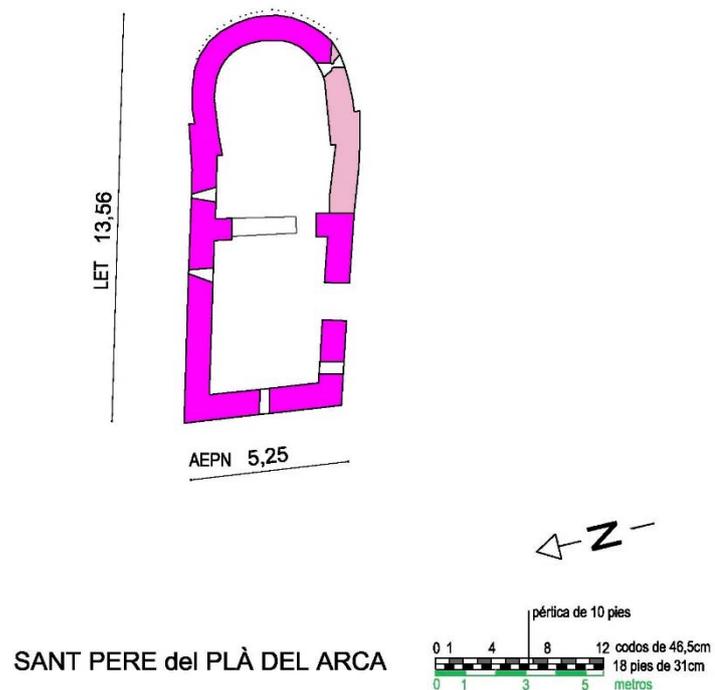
Planta crono-cromática de St. Pere. Elaborada por la autora.
